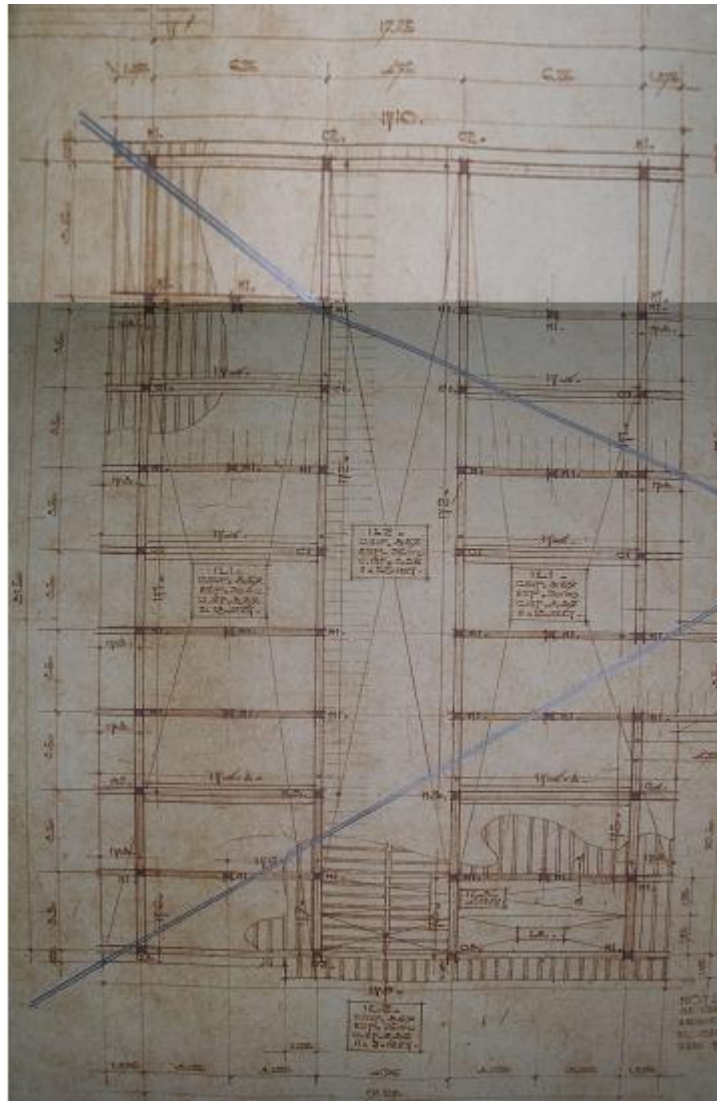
Detalles de Losas, planta baja. Tipo Antigo II
